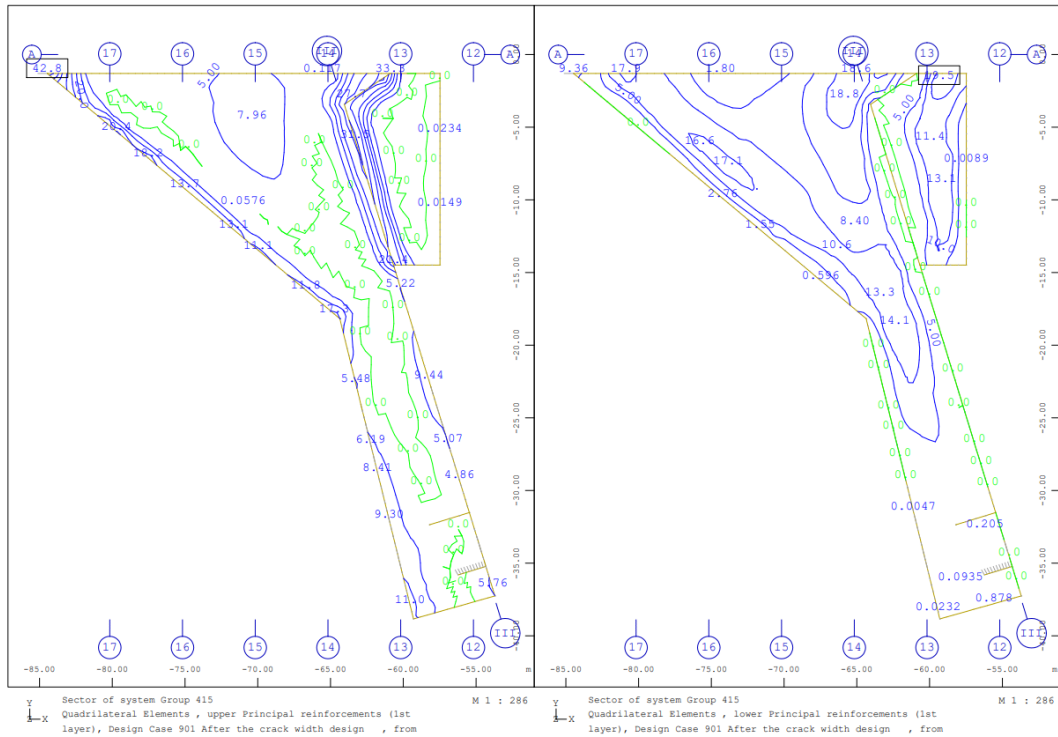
Armadura principal na face inferior (esq.) e superior (dir.) – laje de fundação – acesso Sul - ELS
